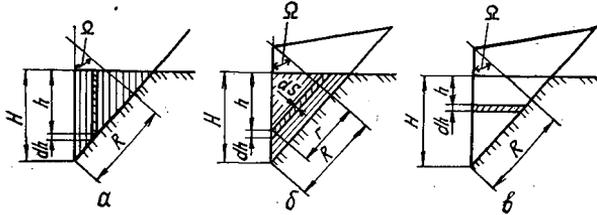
Расчетные схемы: а — для плоской фрезы; б, в — для объемной фрезы
